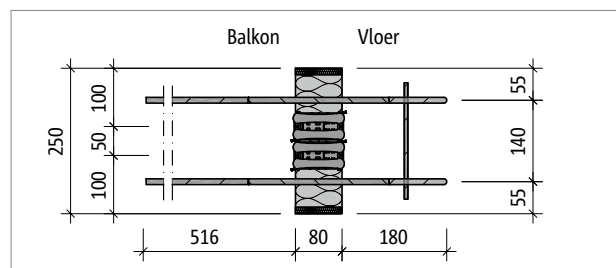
Schöck Isokorf® T type Q-E-V5-L500: Bovenanzicht
